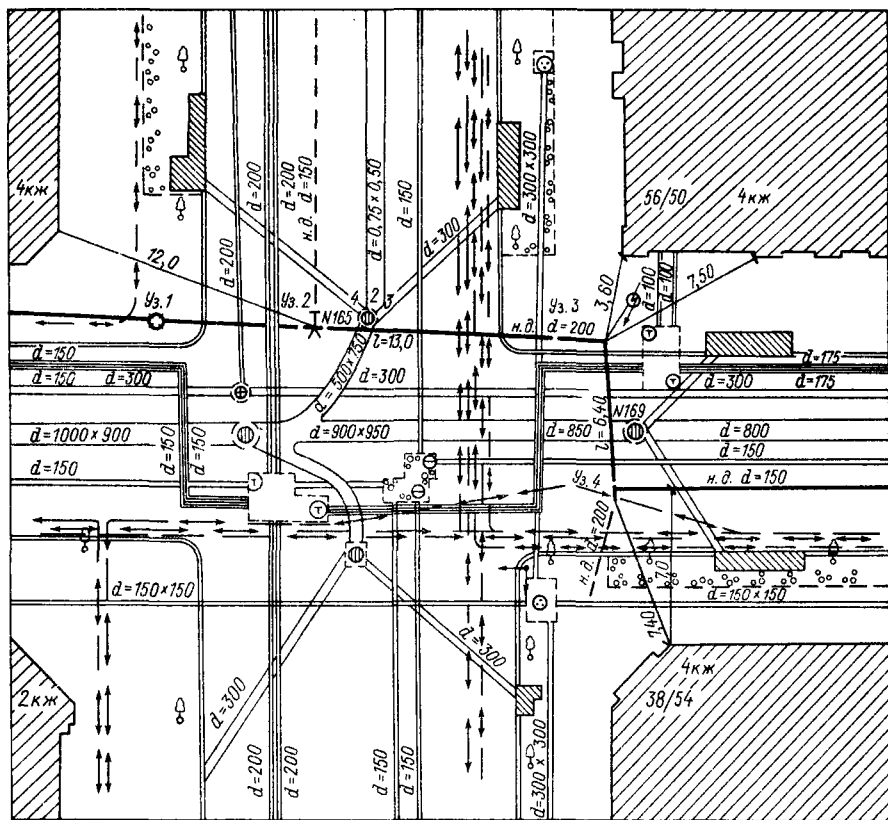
Пример трассировки газопровода на плане проезда,
